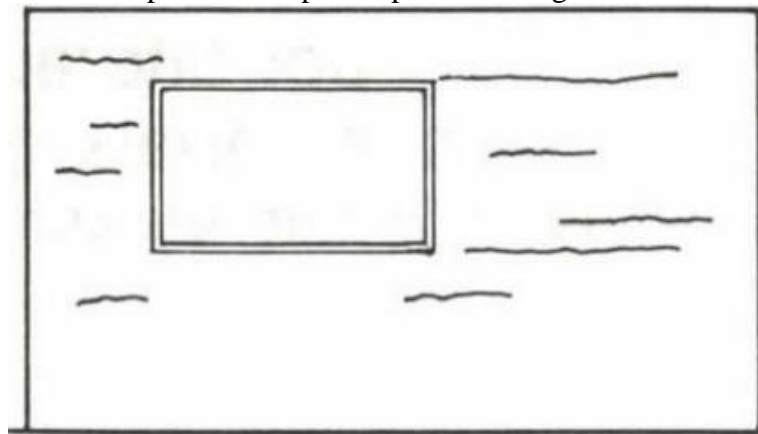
Fissura horizontal devido à movimentação higroscópica
